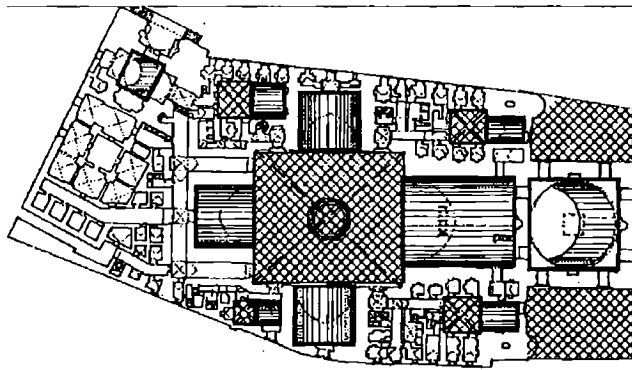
مسقط أفقي مدرسة السلطان حسن
